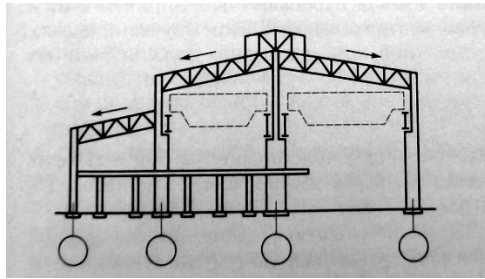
Разрез цеха с двускатным покрытием, перепадом высоты и рабочей площадкой
